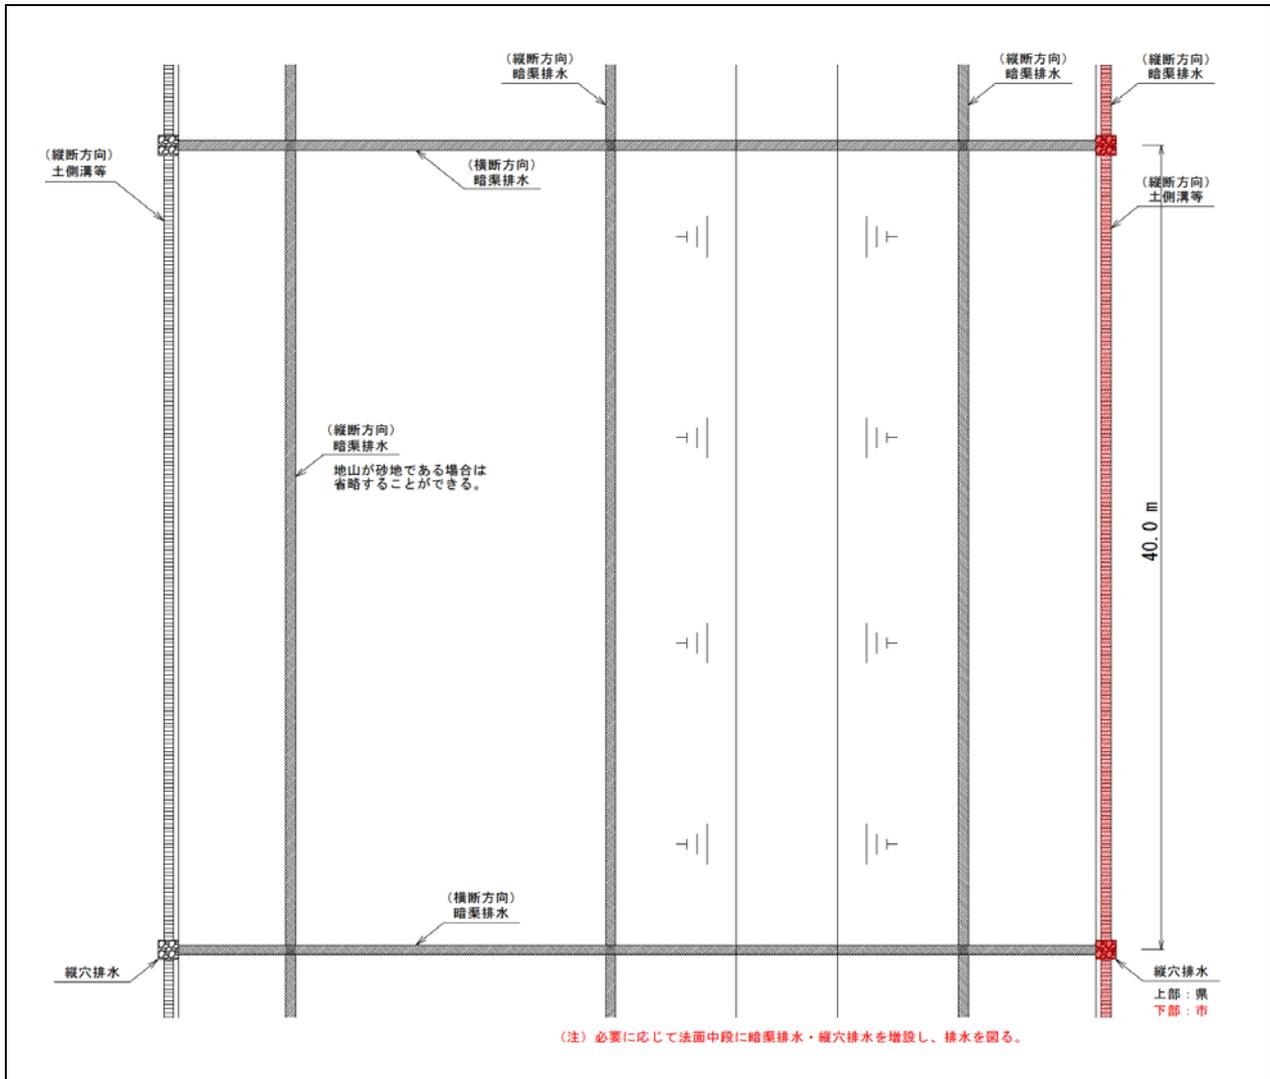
第 2 種建設発生土以上の排水処理平面図 (赤字: 市施工 黒字: 県施工)
